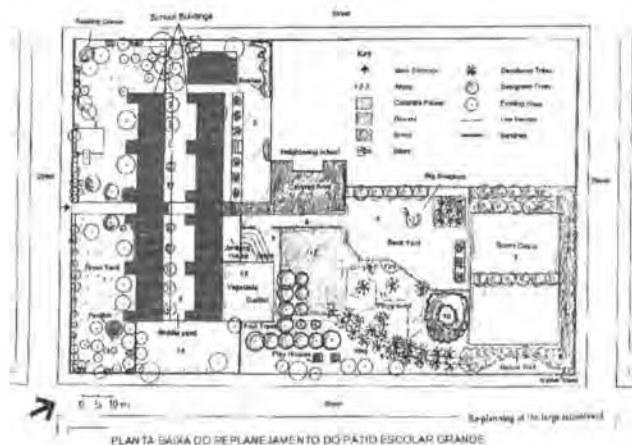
Planta baixa do replanejamento do pátio escolar grande.
